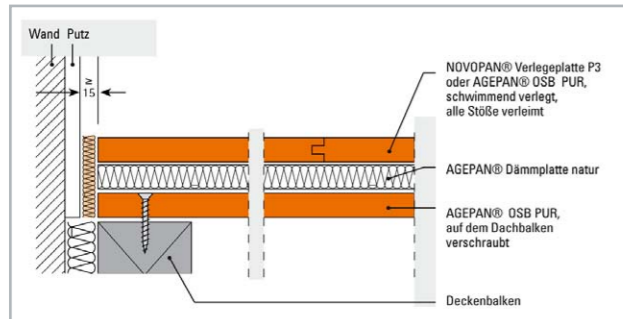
Das schwimmende Verlegen auf Holzbalkendecken mit AGEPAN® Dämmplatten natur.
